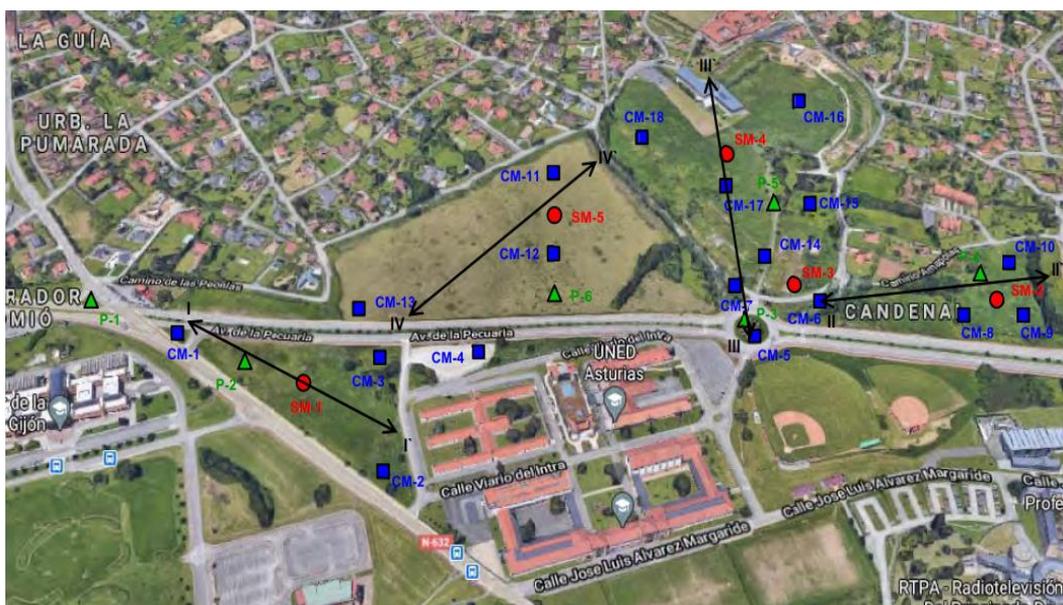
Planta de ubicación de la investigación. Fuente: EG.
